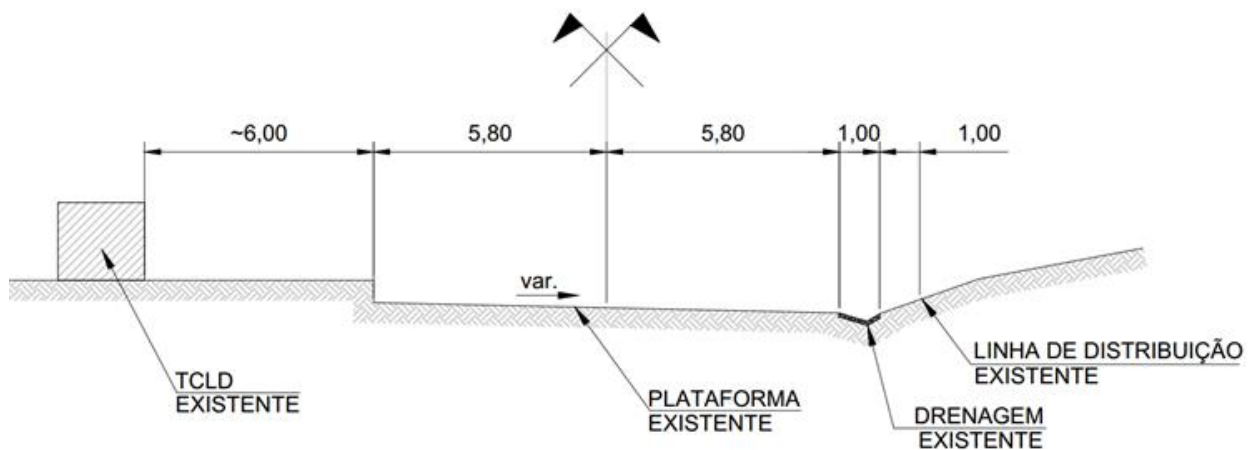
Vista da Seção Transversal Estrada Existente (dimensões aproximadas)
